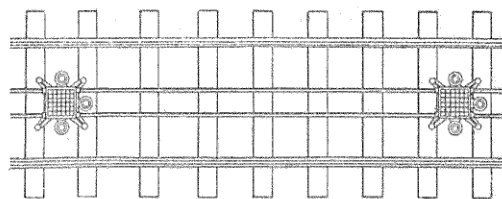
Plan d'une voie Westinghouse sans retour par les rails.
